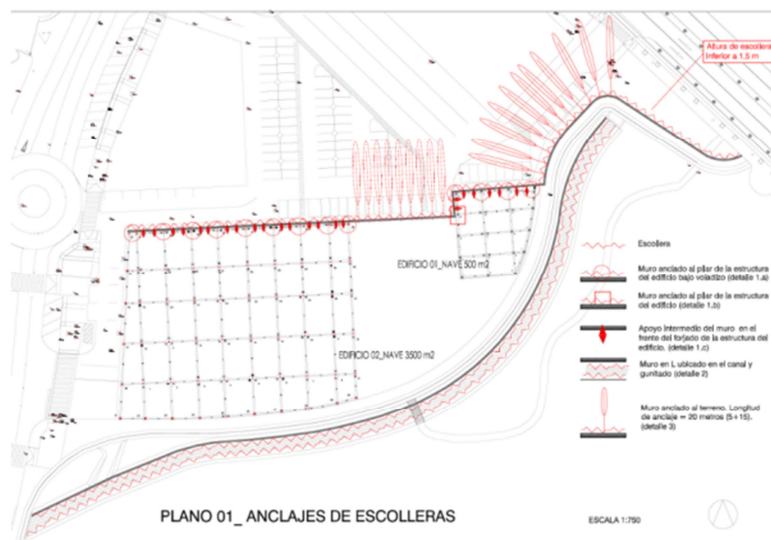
“Croquis de la zona en donde se propone el anclaje del muro”.
